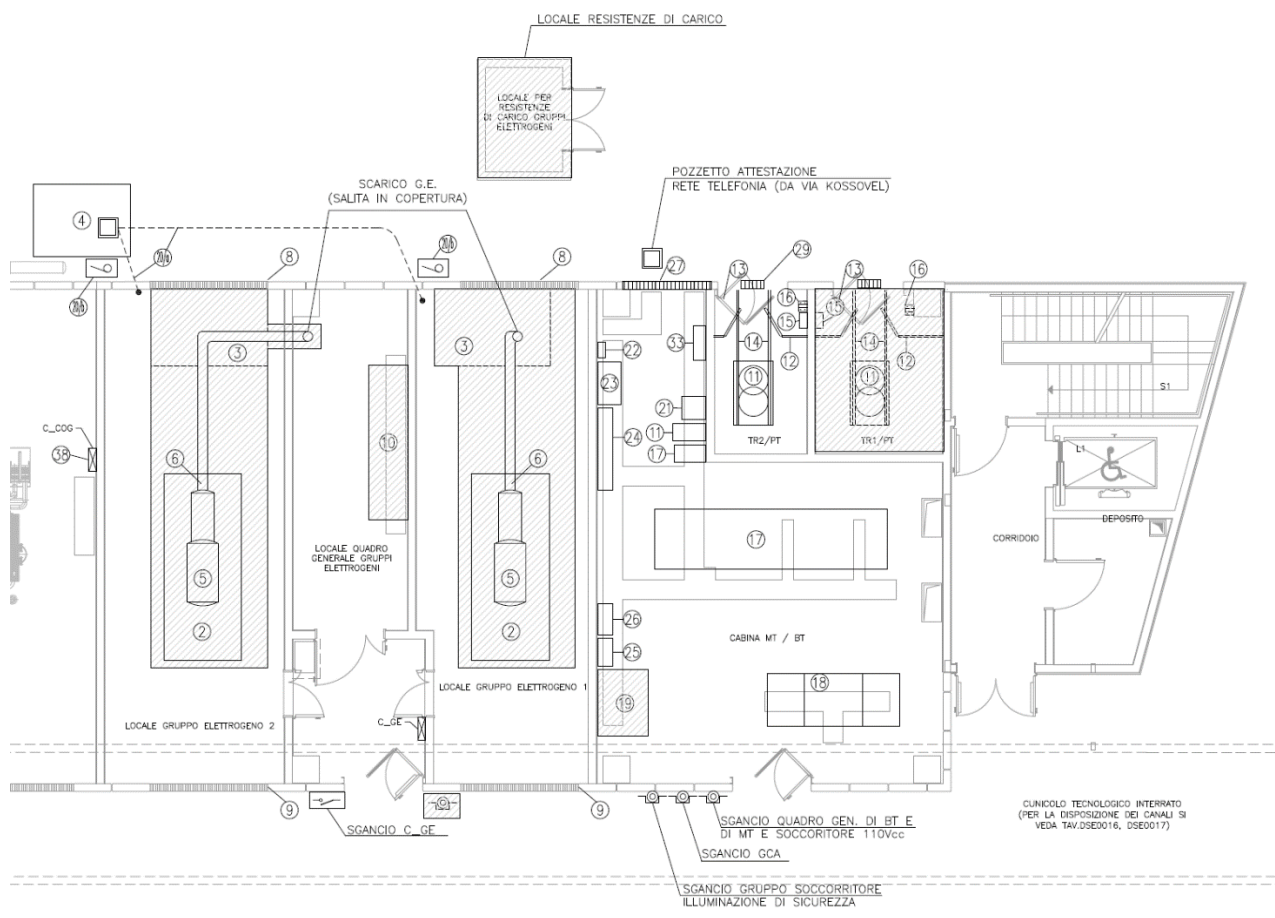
Estratto della planimetria della centrale tecnologica di Basovizza.
